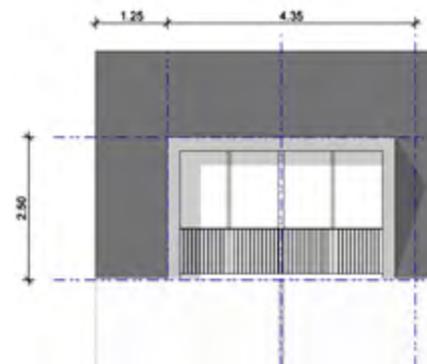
Denkbare Erweiterung der Dachlandschaft - Loggia
